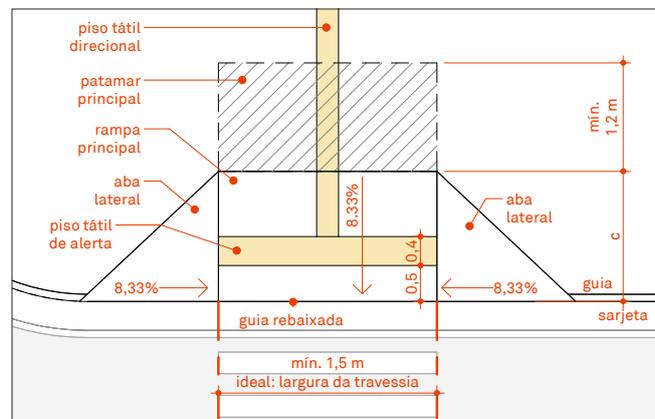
Detalhe do rebaixamento de calçada tipo I.
